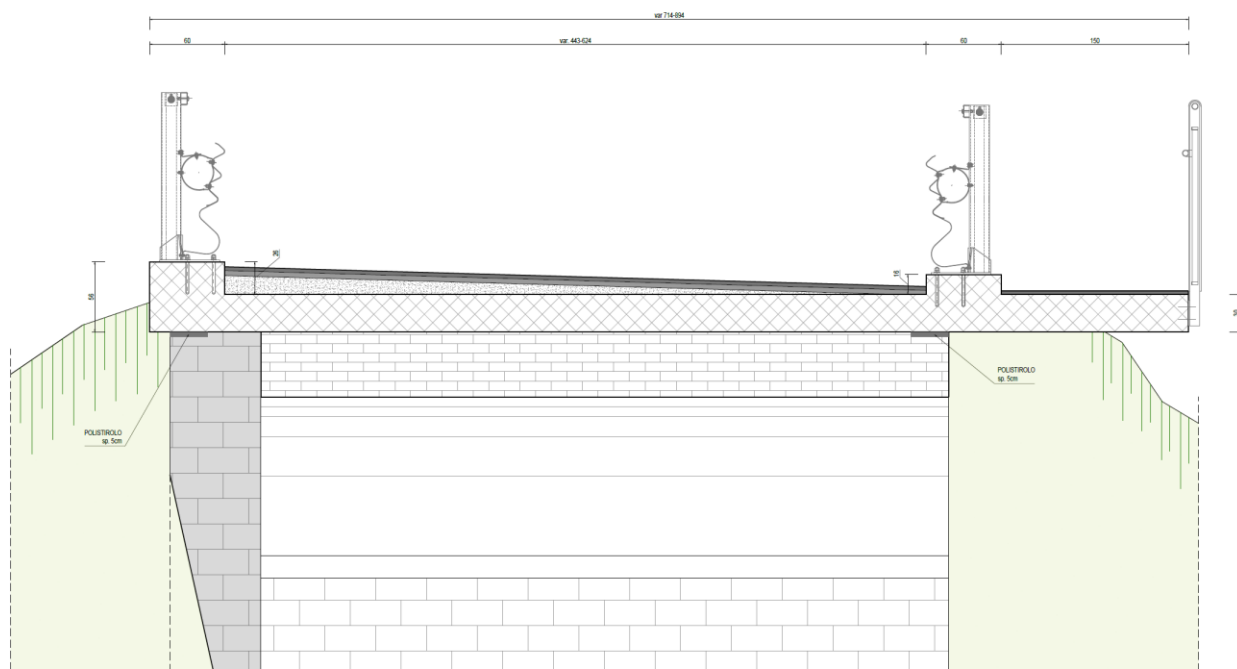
Stato di progetto - Sezione trasversale nuovo impalcato e cordoli
